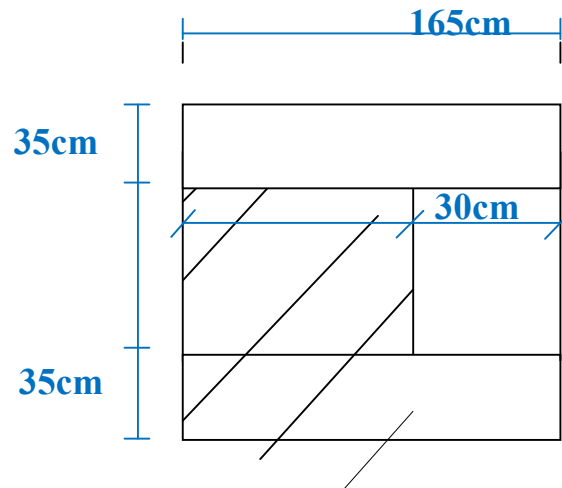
Coupe longitudinale du voussoir sur pile
